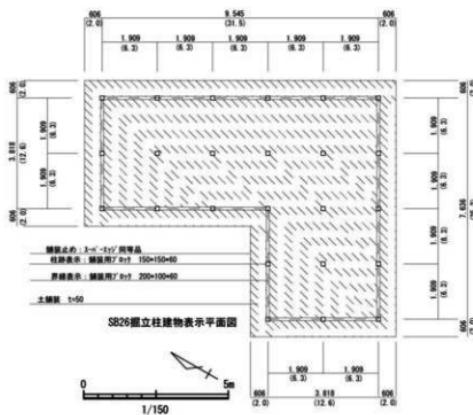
堀立柱建物跡（SB23・SB26）表示平面図
